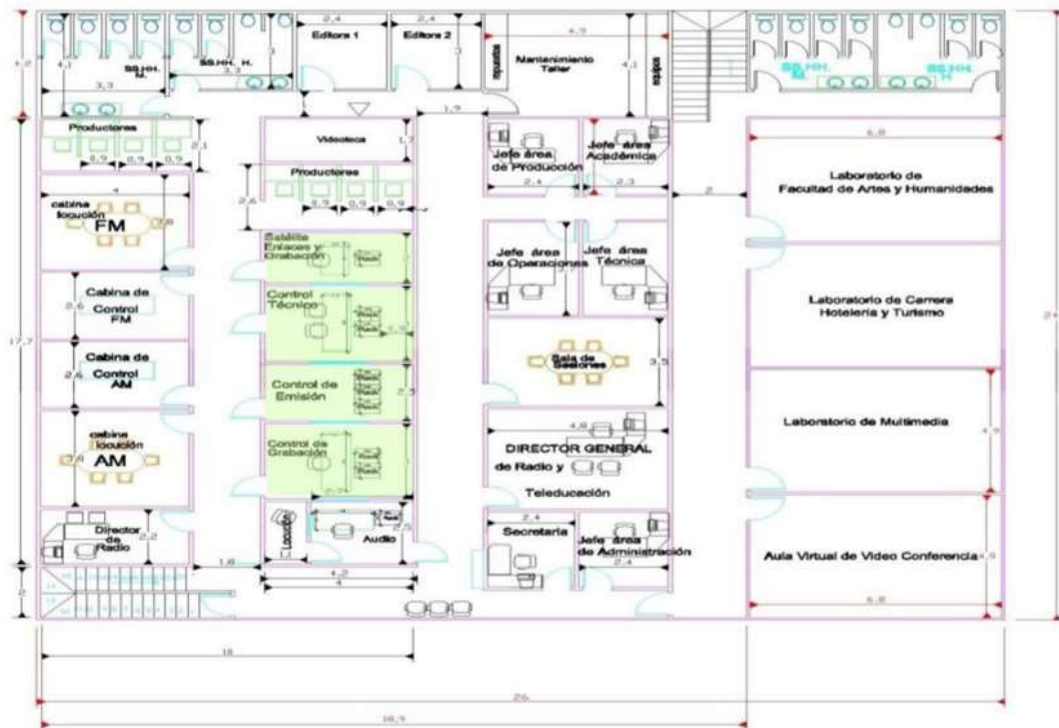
Ubicación de los equipos en la planta alta del canal UCSG
